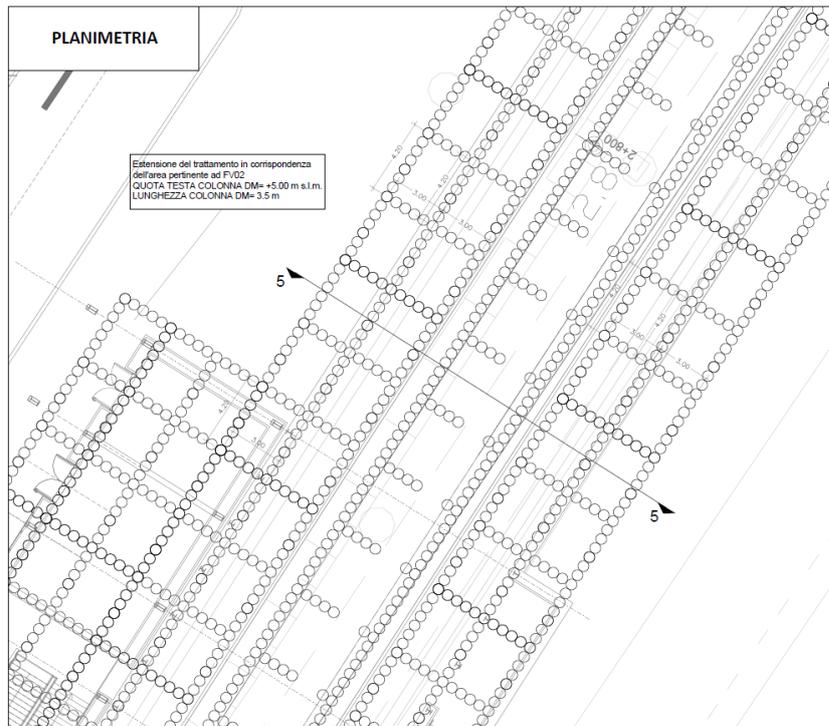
Sezione rappresentativa Fermata Aeroporto tratta 2+710 – 2+960 – planimetria
